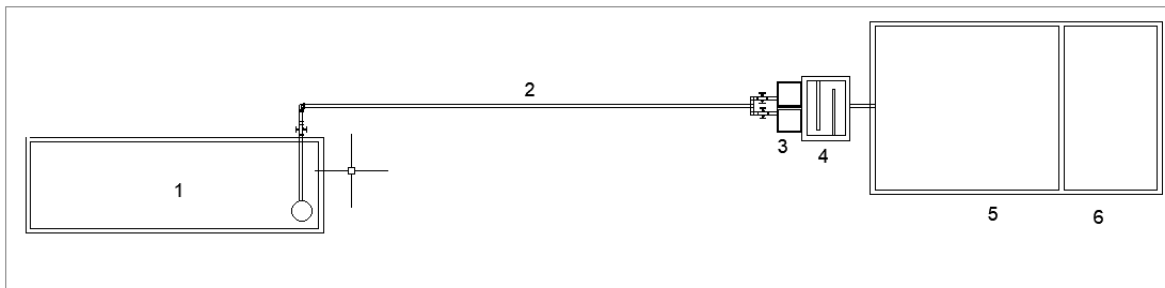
esquemas en planta de tanques de almacenamiento y sistema de tratamiento
